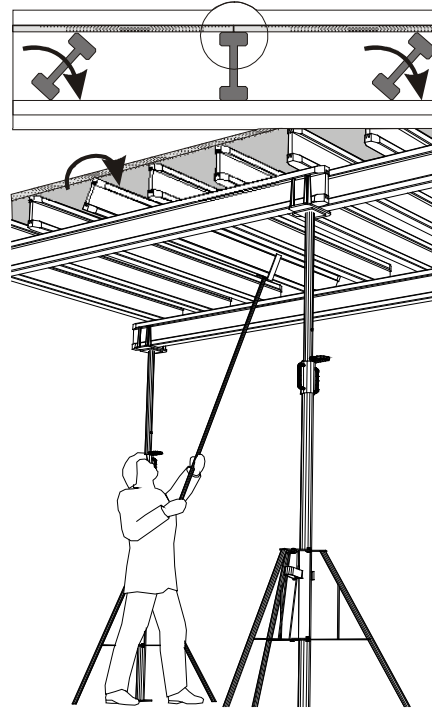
Демонтаж опалубки горизонтальних перекриттів. [16]
